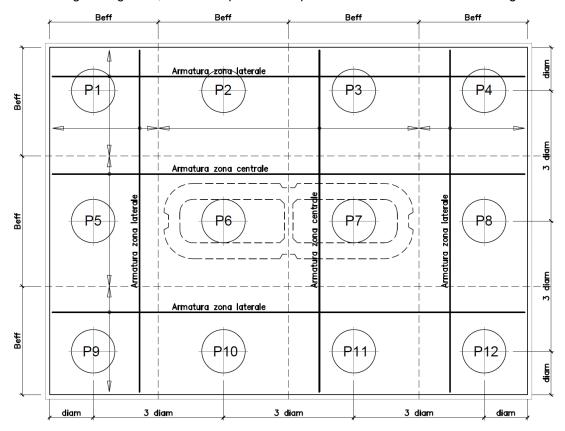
Plinto di fondazione – Armatura longitudinale inferiore e superiore
